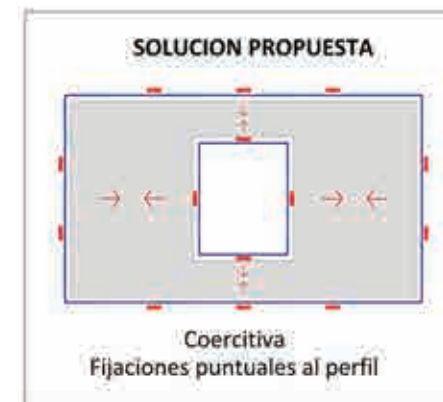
Fijación discontinua del perfil perimetral con la mesa de hormigonado
